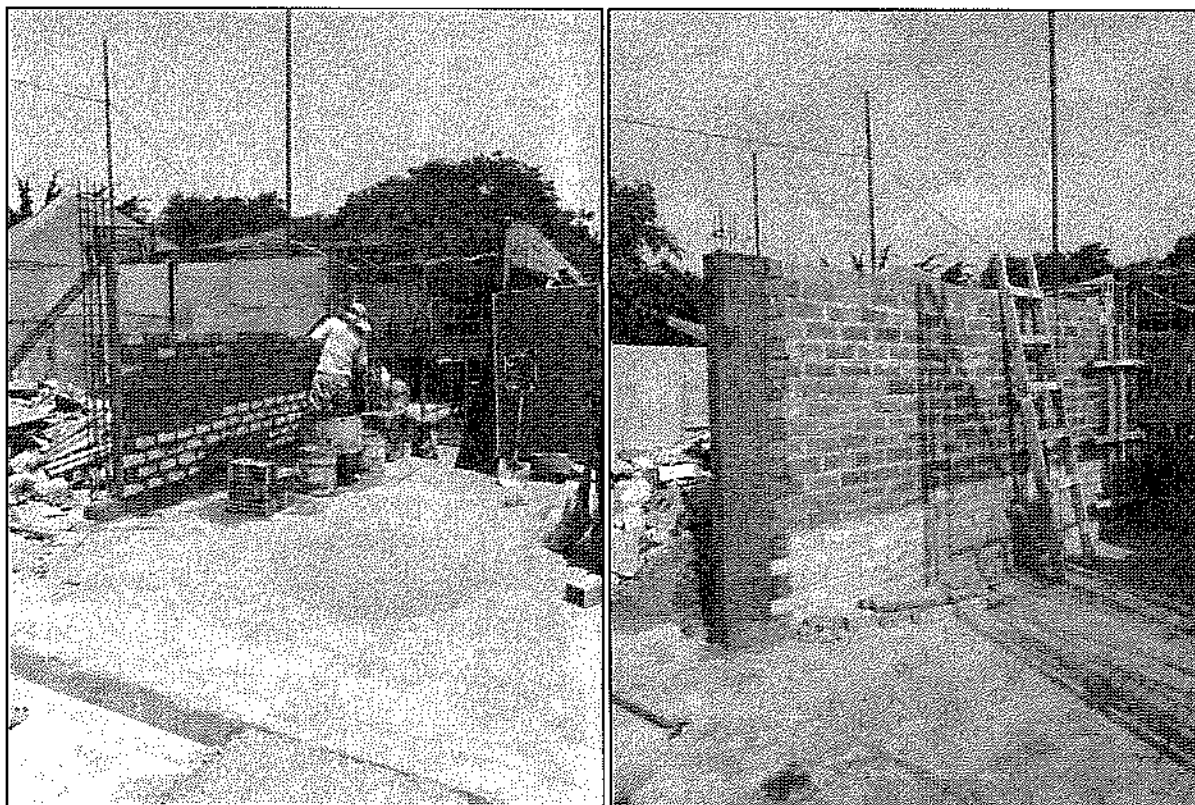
Asentado de ladrillo – Muro sogá -Botadero
